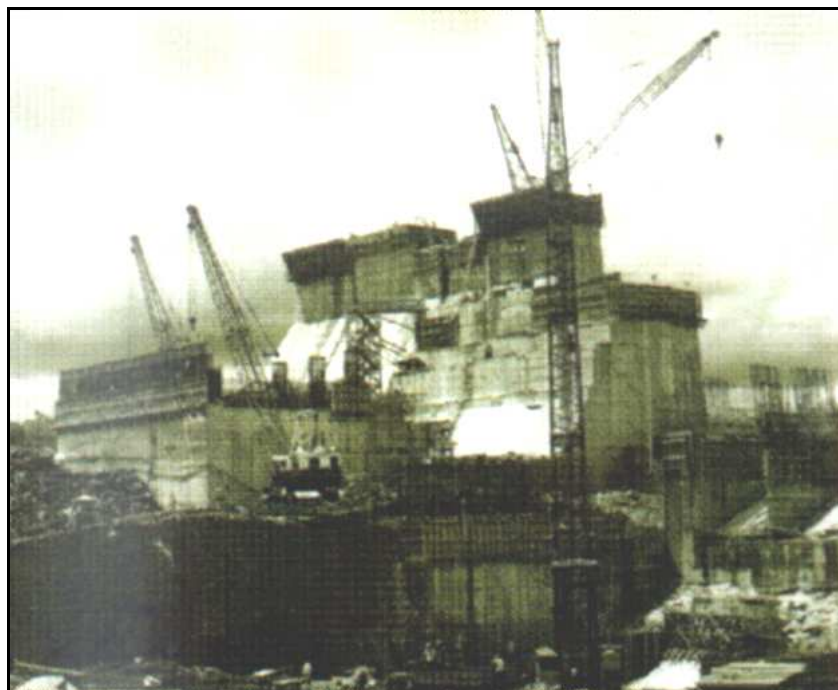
Vista da Construção da UHE Porto Colômbia (FONTE: FURNAS).
